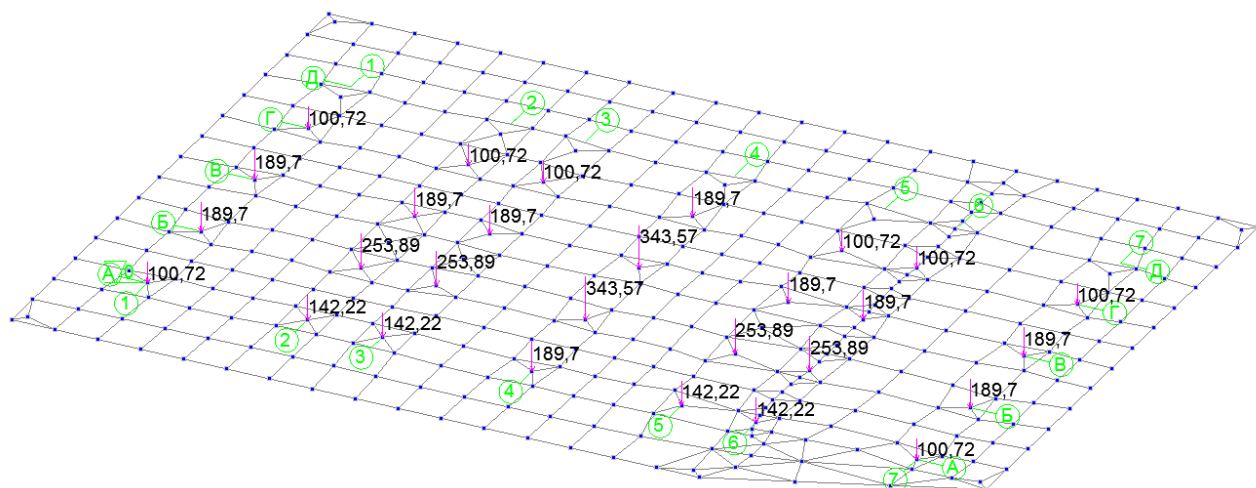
Постоянная нагрузка на фундаментную плиту от плит покрытия, перекрытия и тех.этажа.
